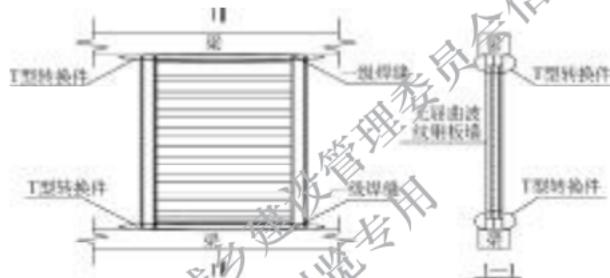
无屈曲波纹钢板墙与框架梁焊缝连接形式
